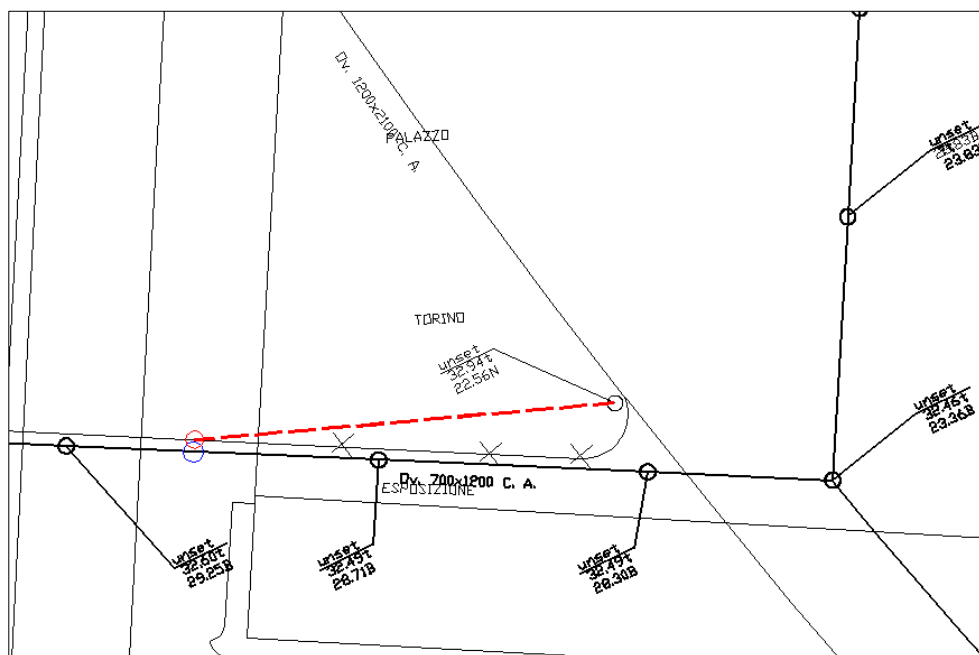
Planimetria rete fognaria – nera interferente: proposta di risoluzione
